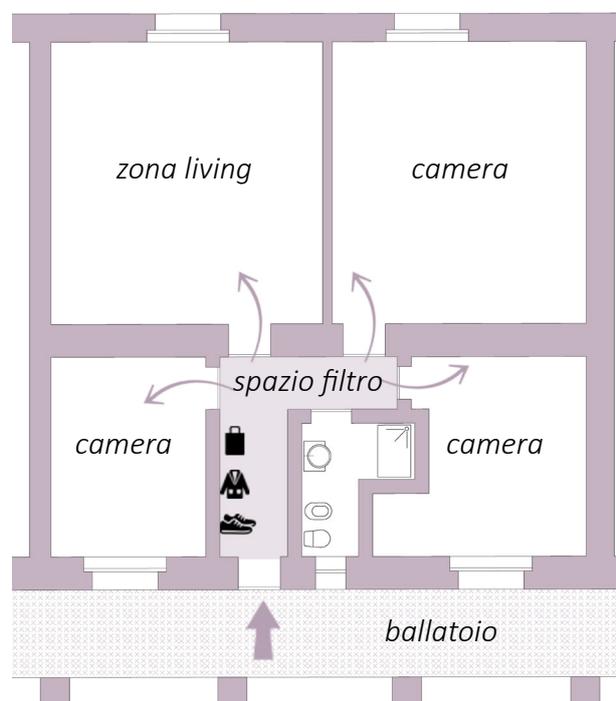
Rappresentazione planimetrica dell' ambiente ballatoio - ingresso.
